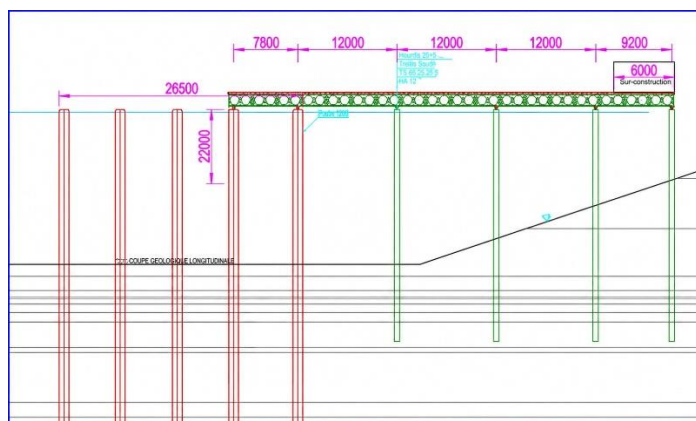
Construction de plateforme métallique pour les pieux de jet grouting.
